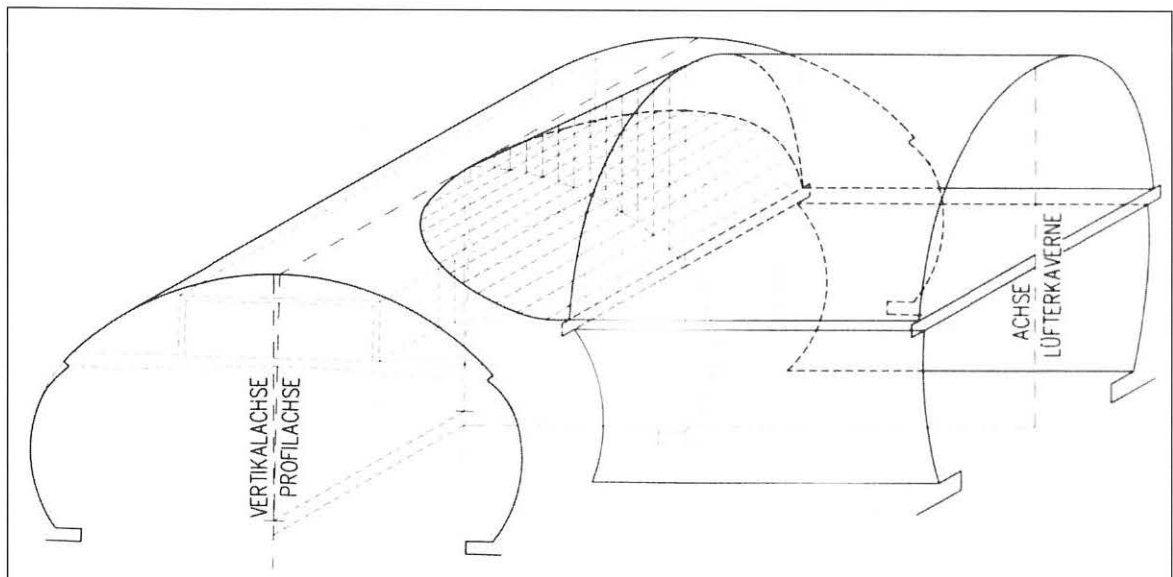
Axiometrische Darstellung der Verschneidung Haupttunnel mit Lüfterkaverne
